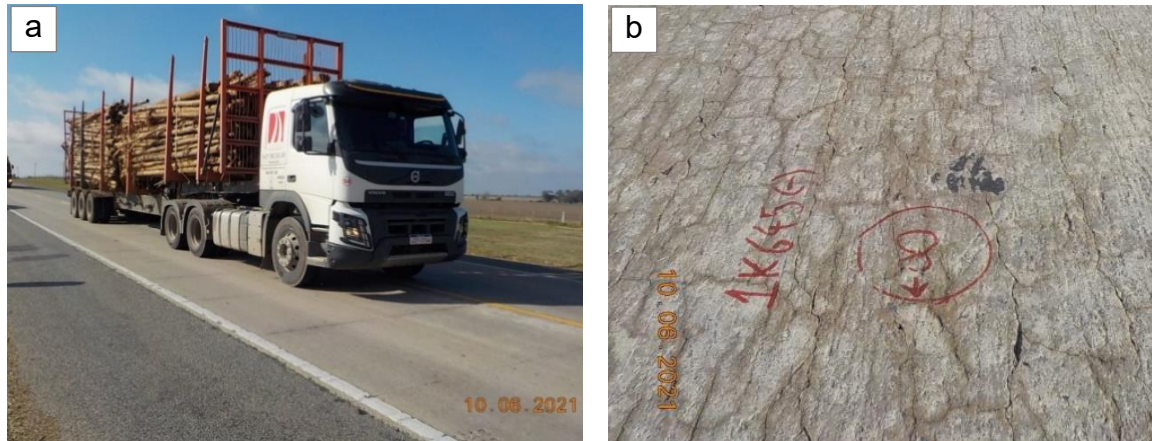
a) Vista de los vehículos típicos que transitan la RN 24; b) Aspecto del patrón de fisuras existente en la superficie del pavimento.
